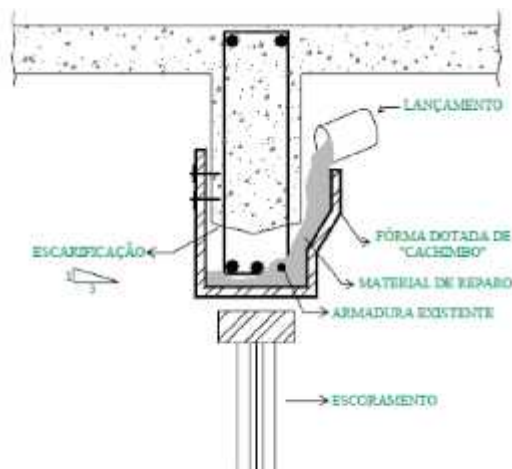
Aplicação convencional de material na reparação de vigas (Ferri, 2007).
